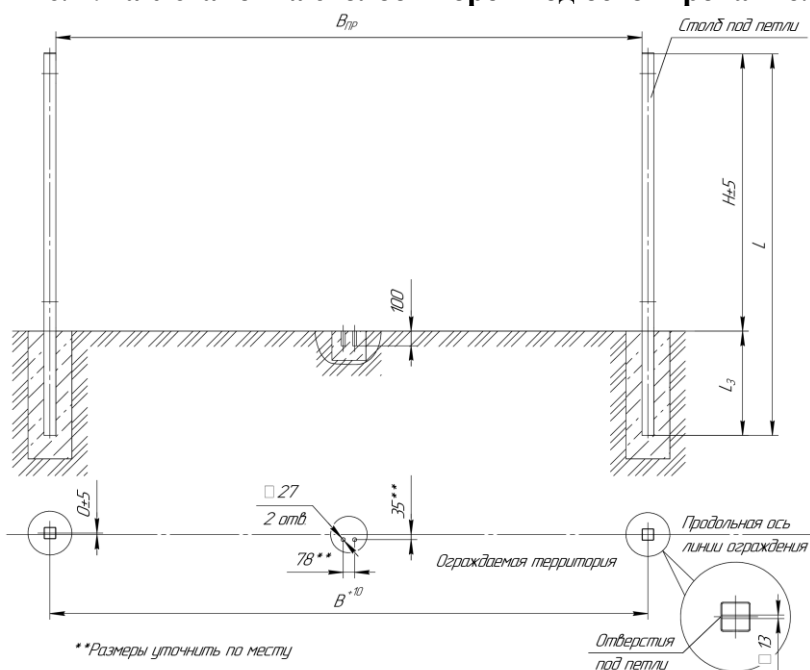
б Установка столбов ворот F3D под бетонирование.
